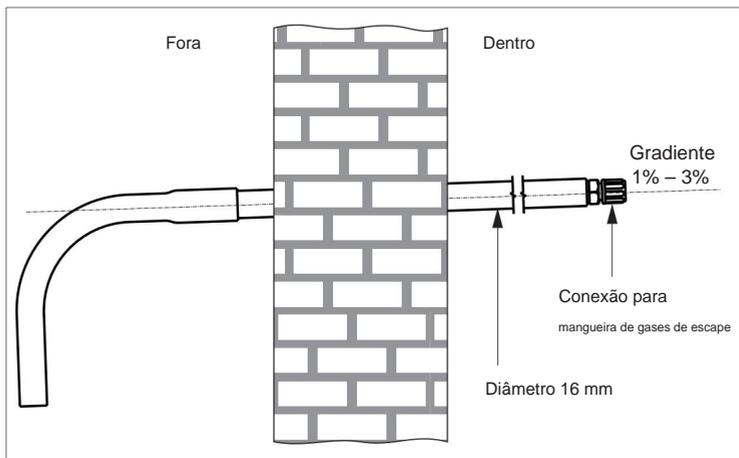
Condução de parede – instalação em parede externa (esquema)
